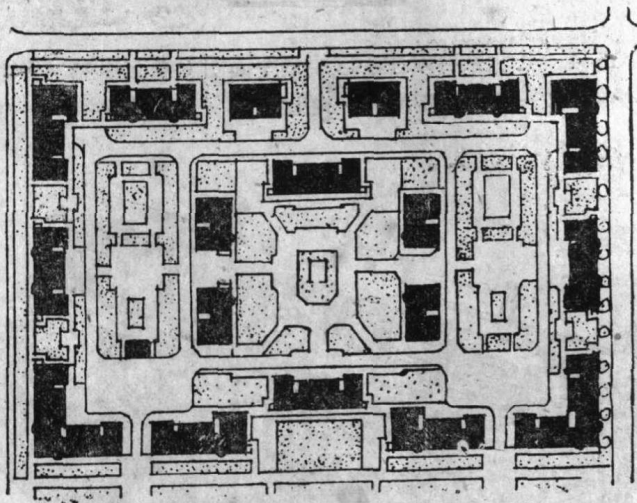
B 苏联札波罗什城少层建筑街坊(2层)平面图
